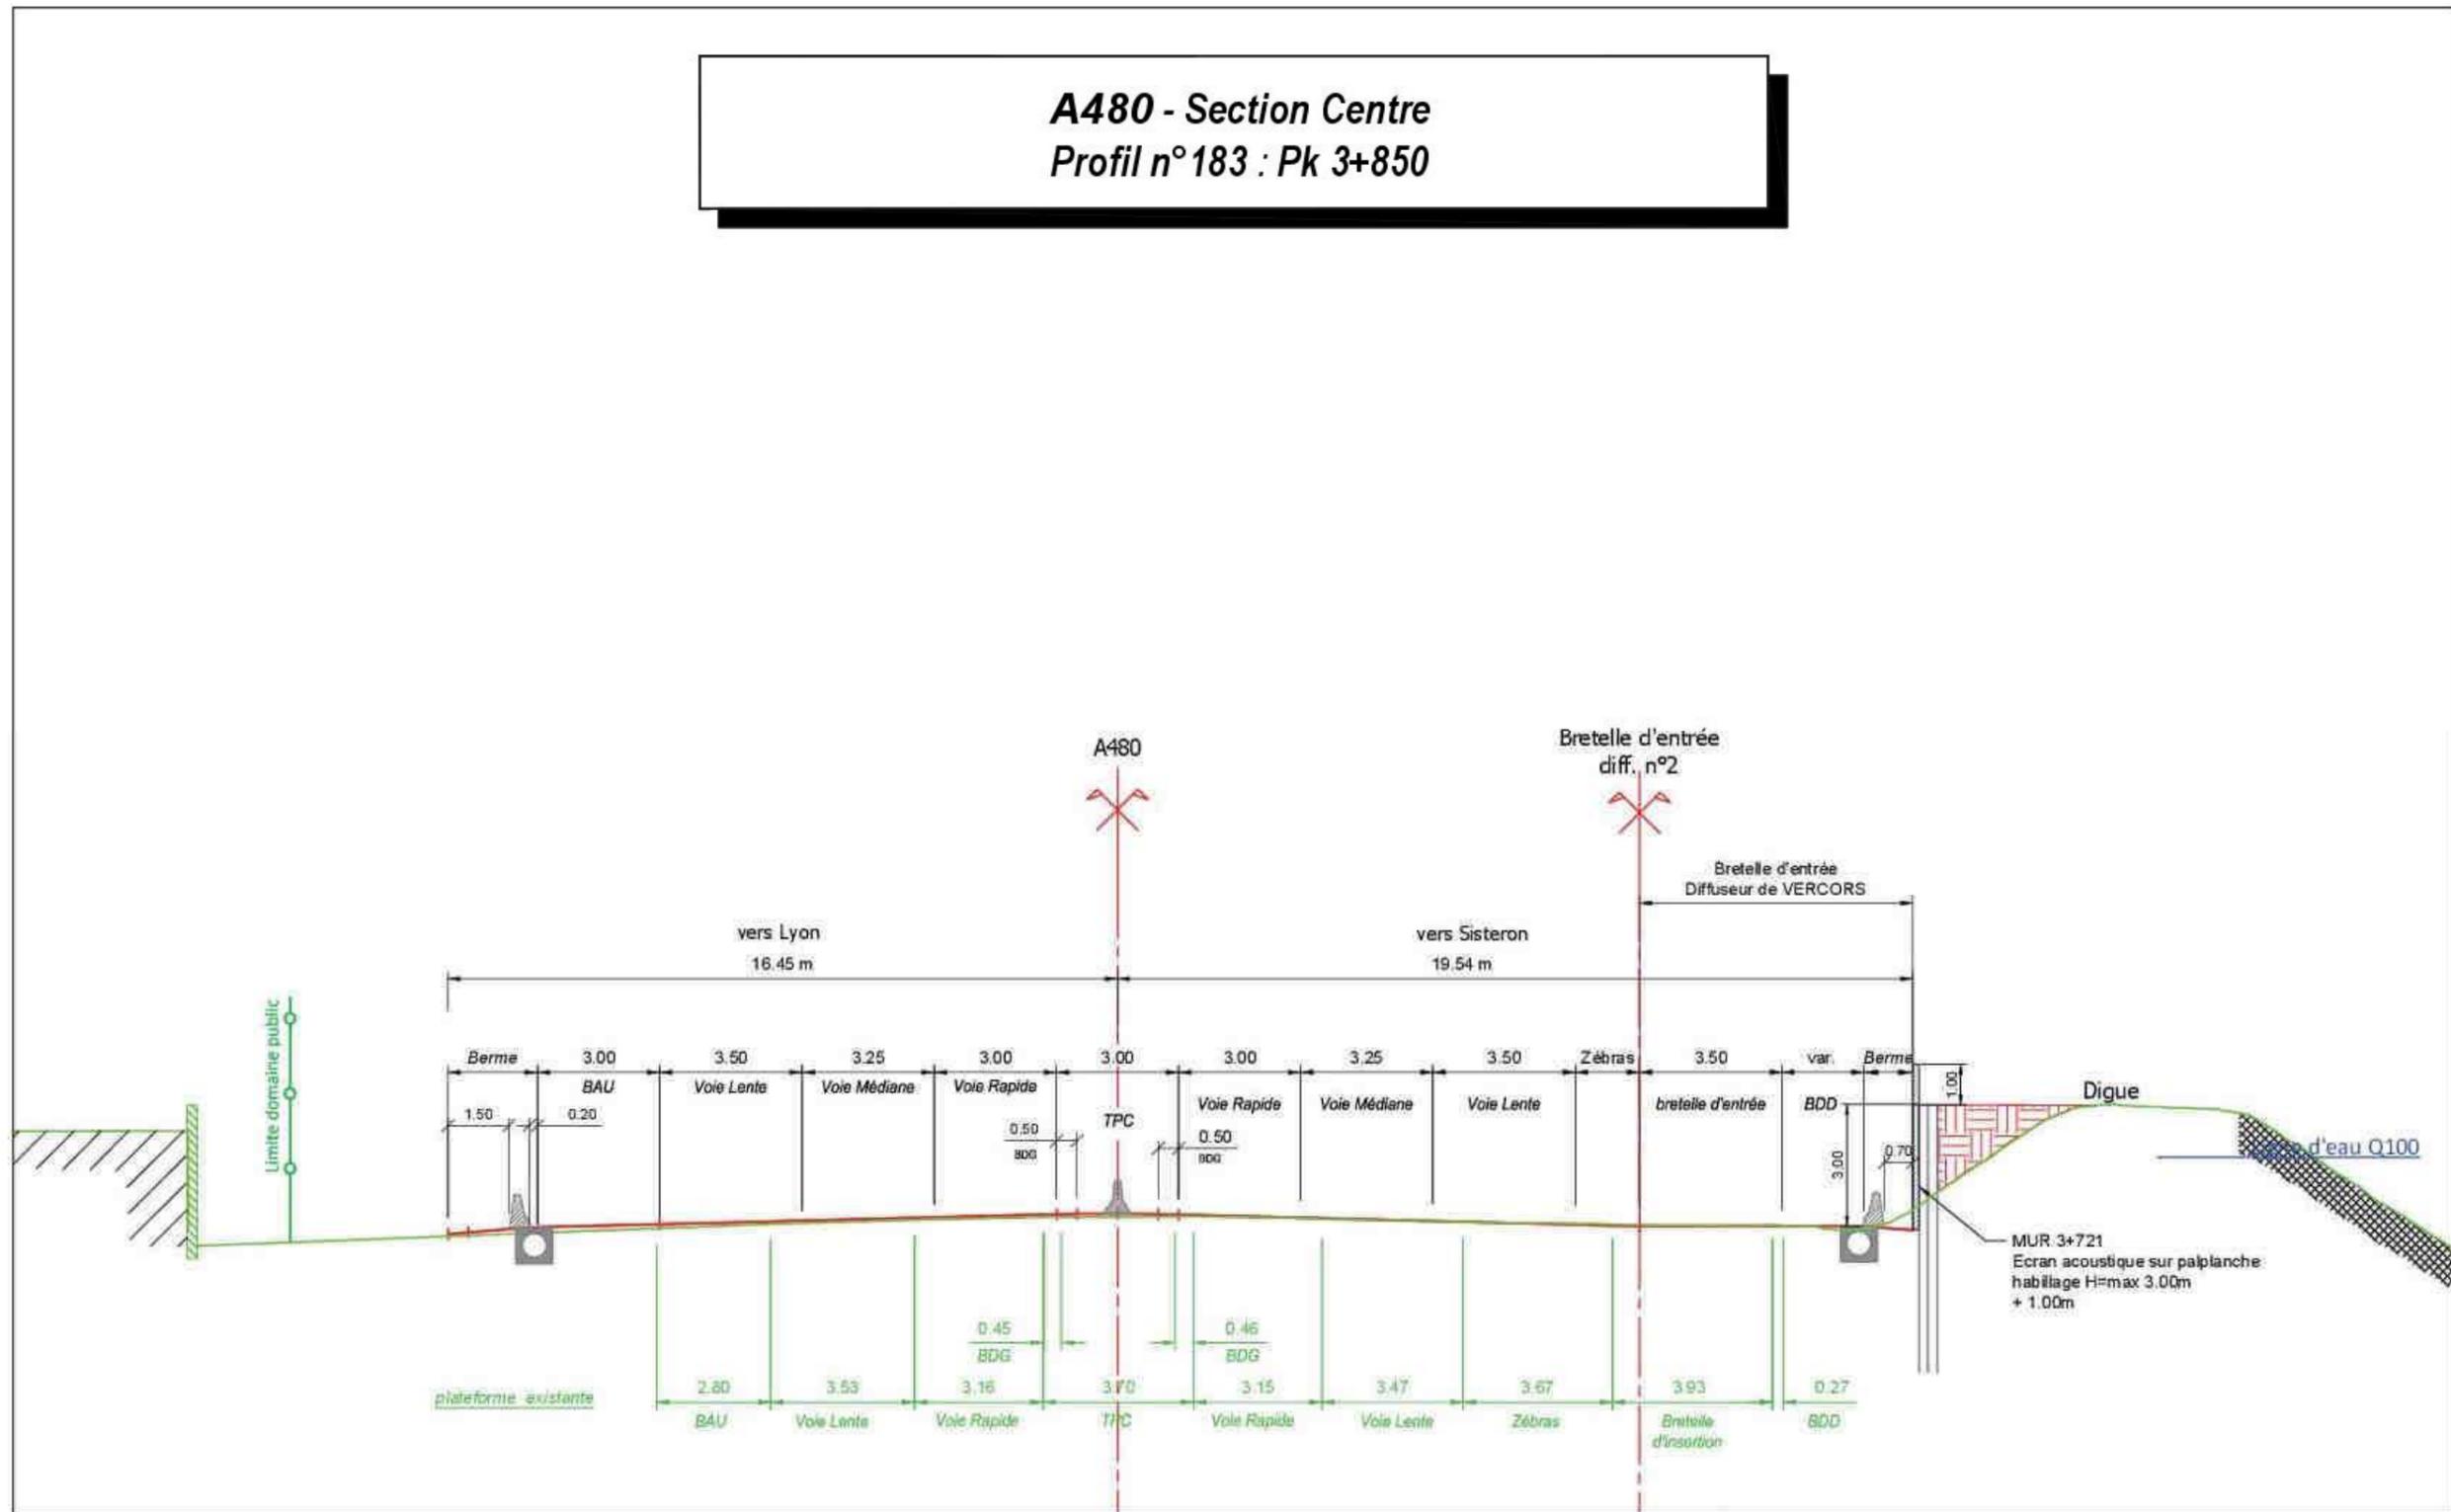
Vue en plan et coupe type en zone 2 (PT183)
